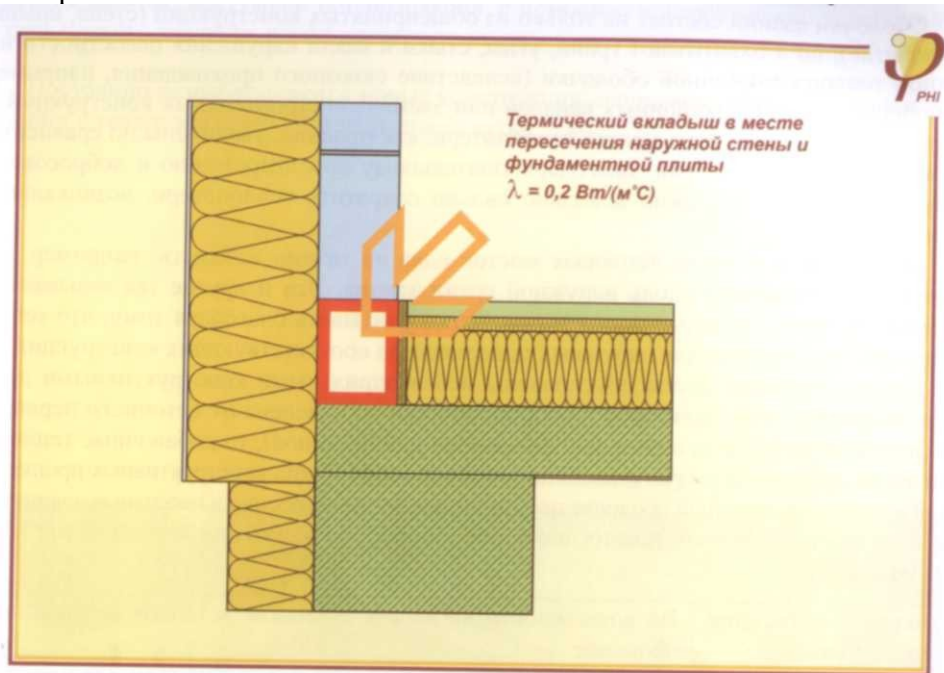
Стык с минимальными теплопотерями между теплоизоляцией плиты перекрытия над подвалом и теплоизоляцией наружной стены
